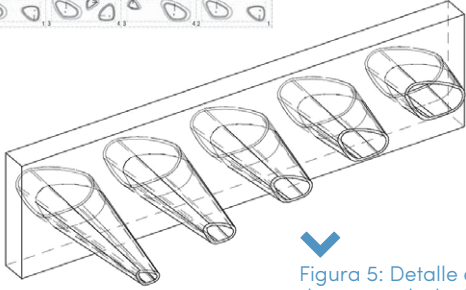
Detalle de la tipología de conos de la fachada occidental.
